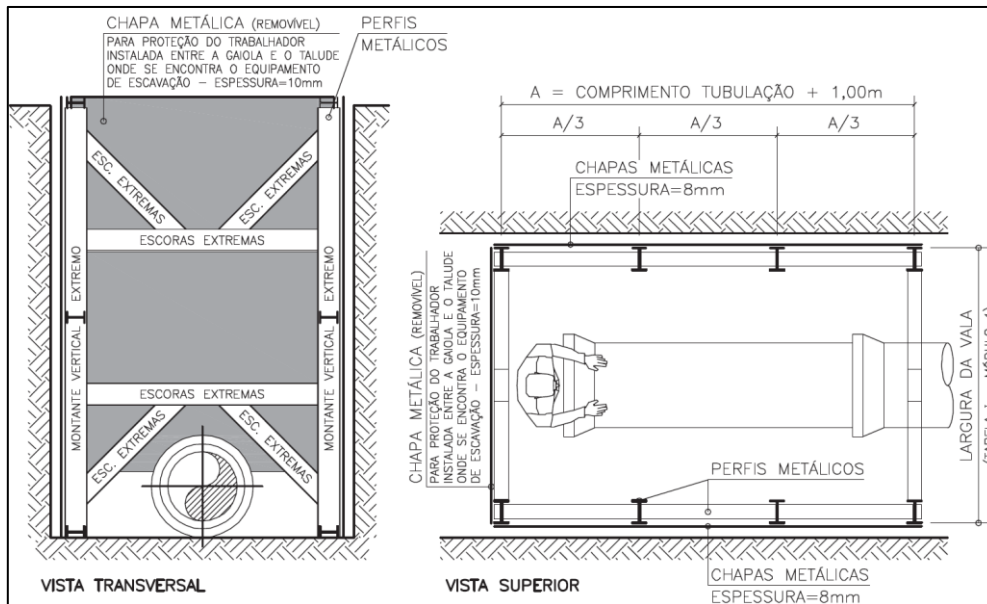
Detalhe em planta do escoramento metálico tipo blindagem (gaiola)
